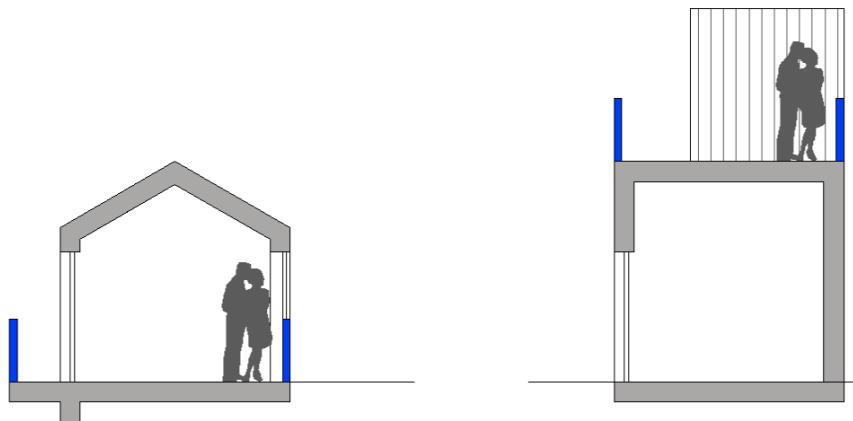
Protection contre les chutes d'installations PV: balcons, garde-corps, etc.
